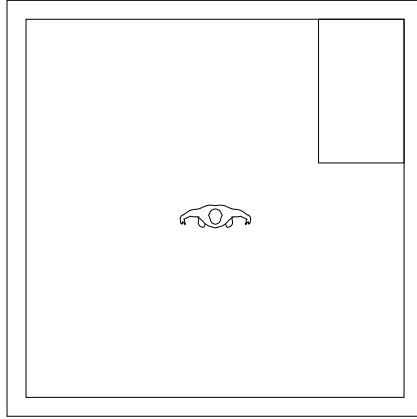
Pos. IV.I | Grundriss – M.1:100
